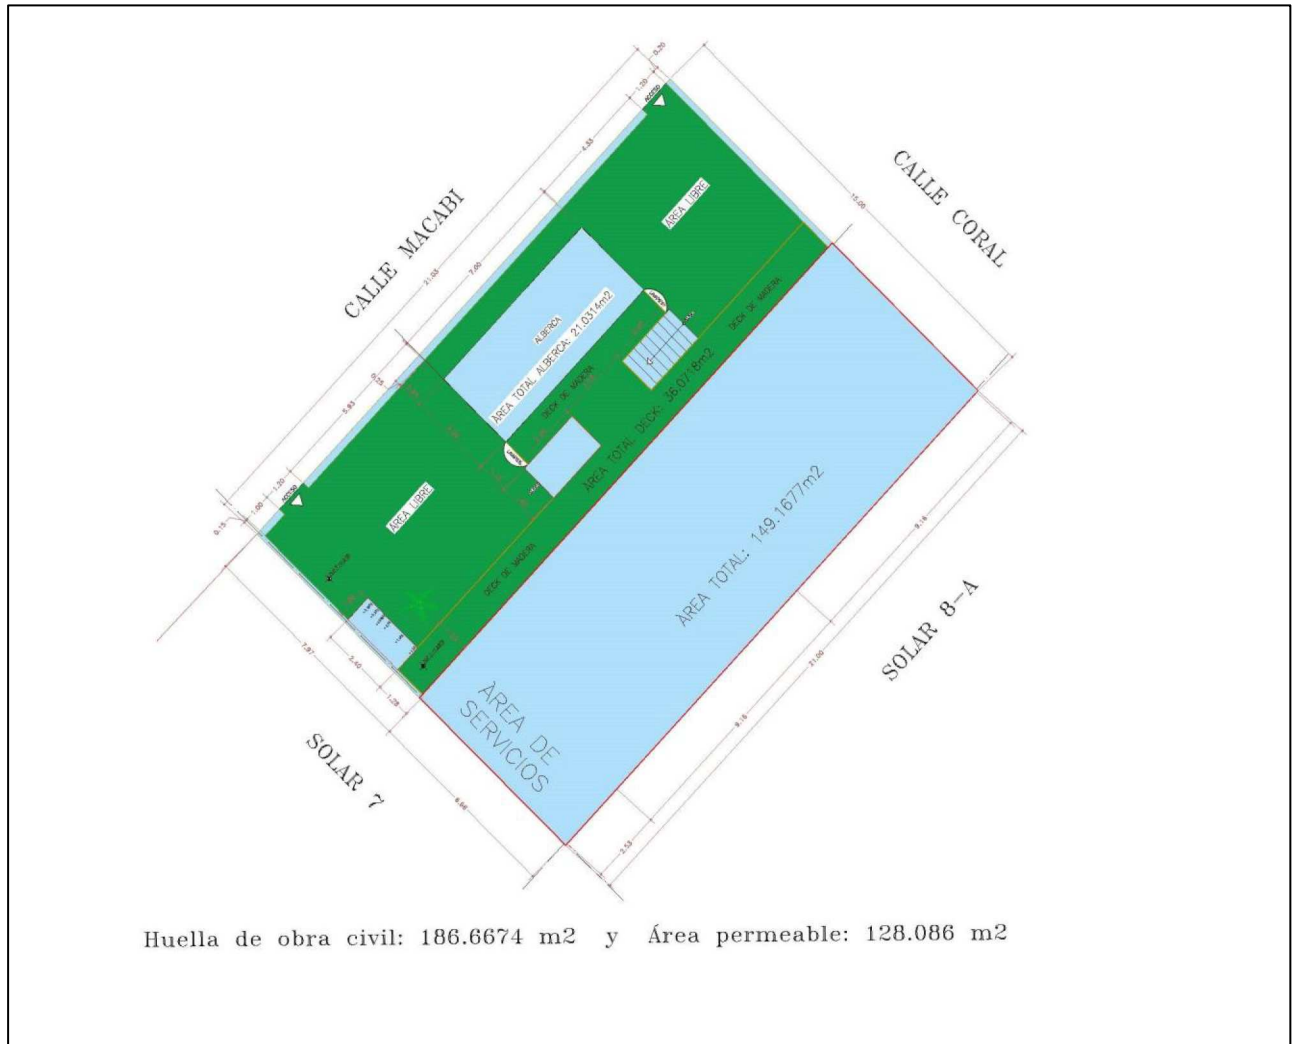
Diseño y distribución arquitectónica de la planta baja del proyecto
